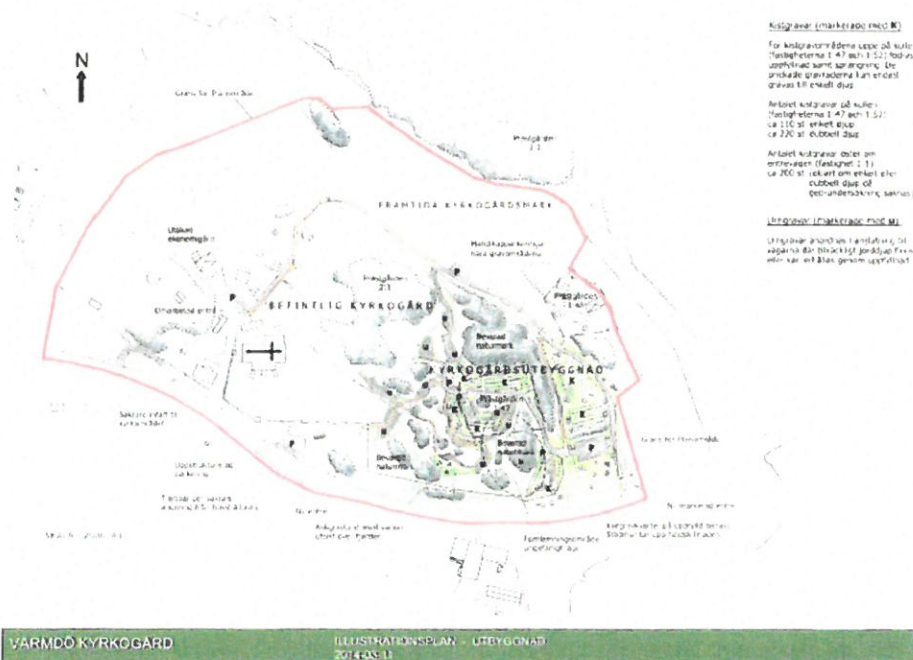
Illustrationsplan 2014-03-11, utbyggnad Värmdö kyrkogård
